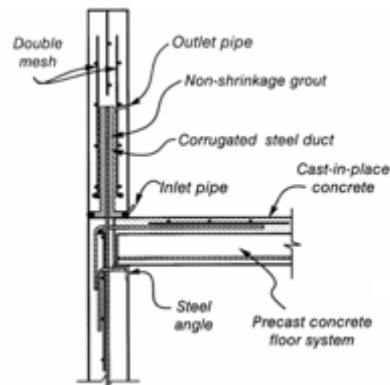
Muro dividido con unión horizontal (fib, 2003).
